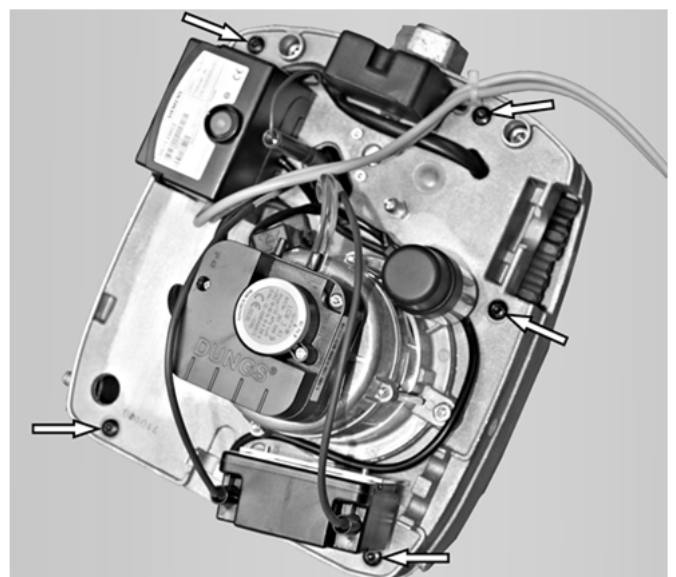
Gehäusedeckel mit 5 Schnellverschluss-Schrauben
